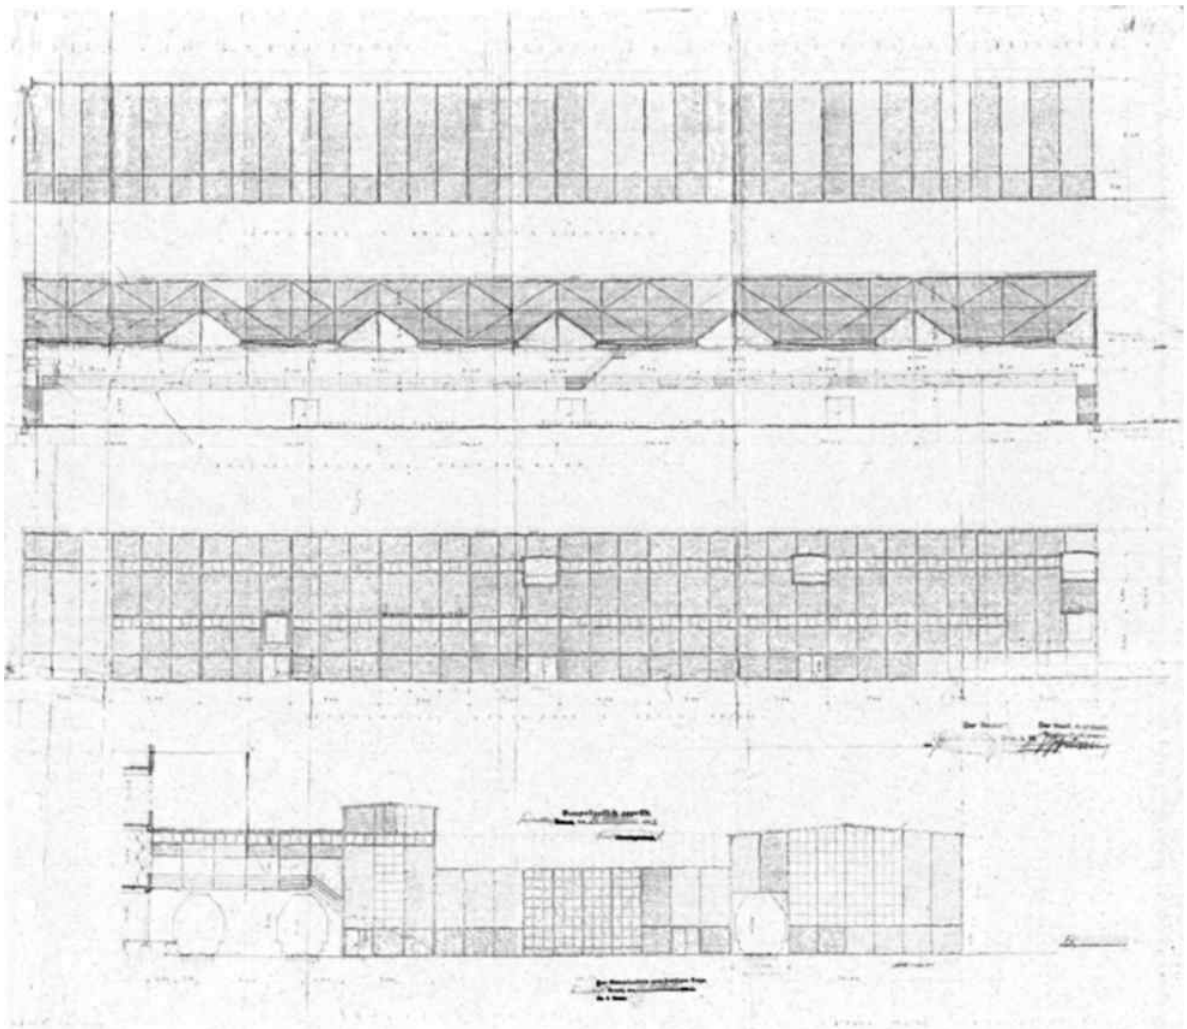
Errichtung Kistenfabrik Geb. B 03, 1929 - Architekt: Walter Furthmann
